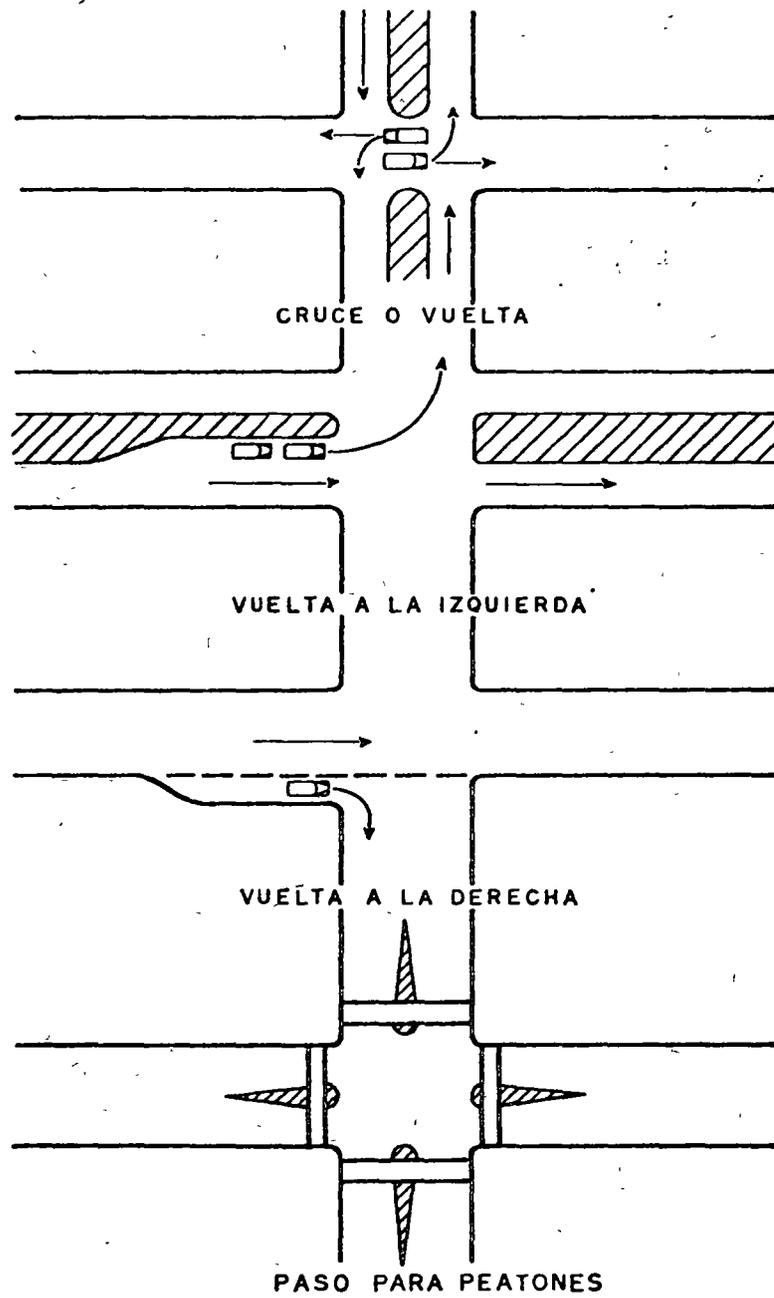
EJEMPLOS DE ZONAS DE PROTECCION
